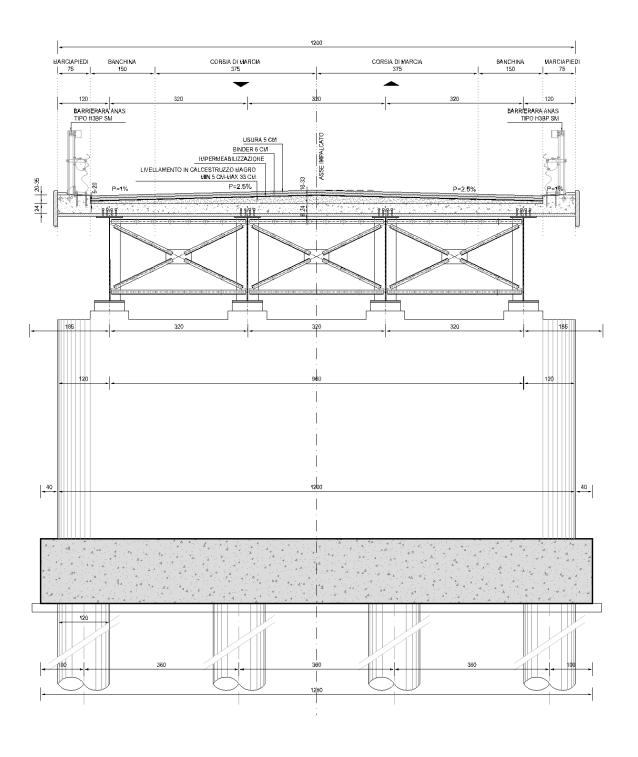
SEZIONE IMPALCATO (SU PILA)
